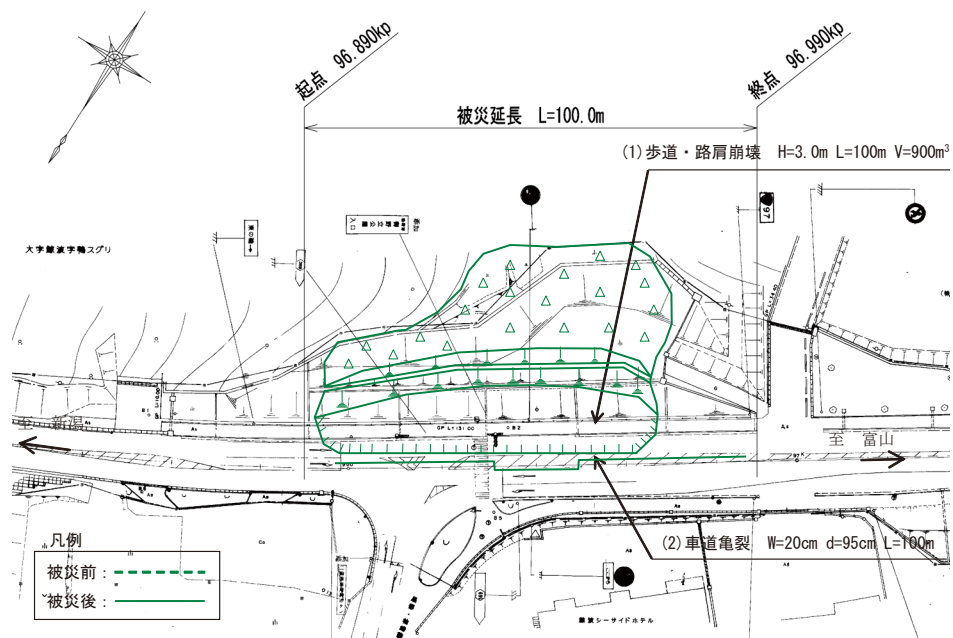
被災箇所平面図（国道8号 柏崎市鯨波地先）
